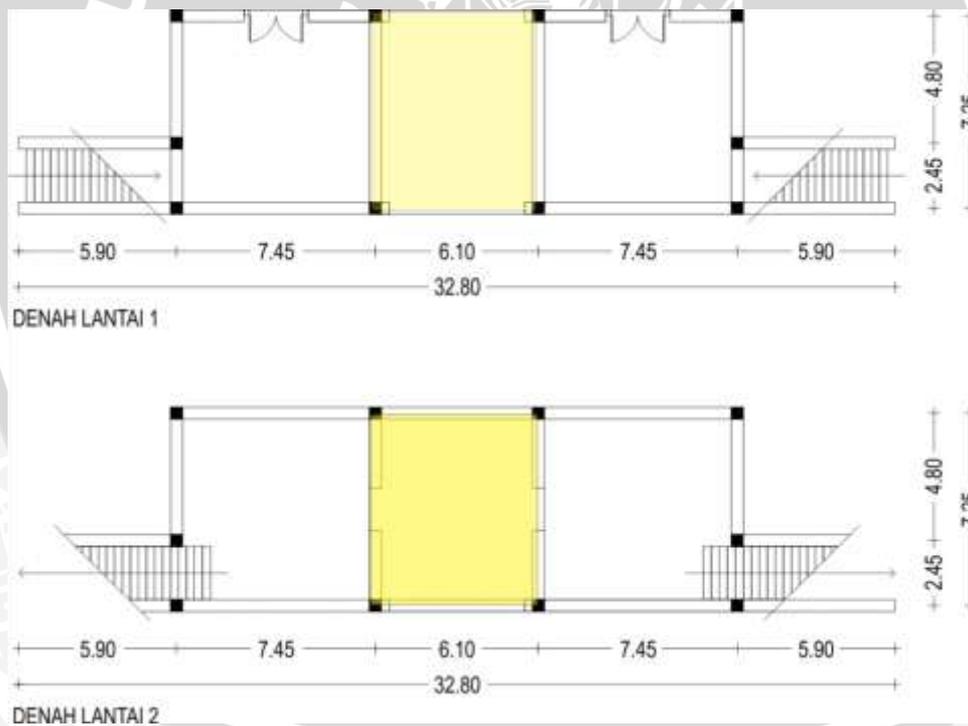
Alur sirkulasi pada bangunan gapura
